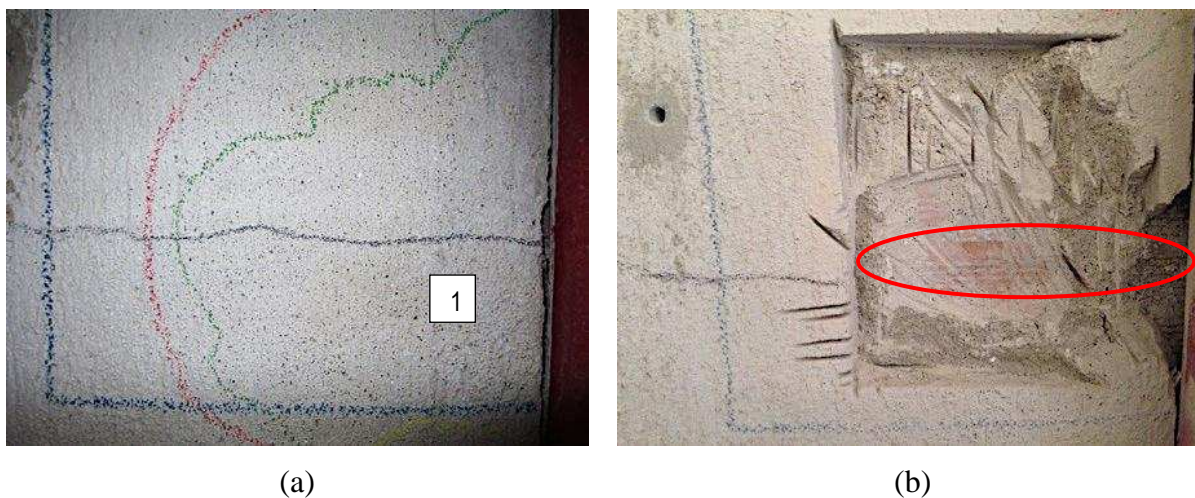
Face interna do modelo experimental PAR-JV-R1 com identificação das regiões onde apareceram as manchas de umidade e destaque para as fissuras horizontais.
